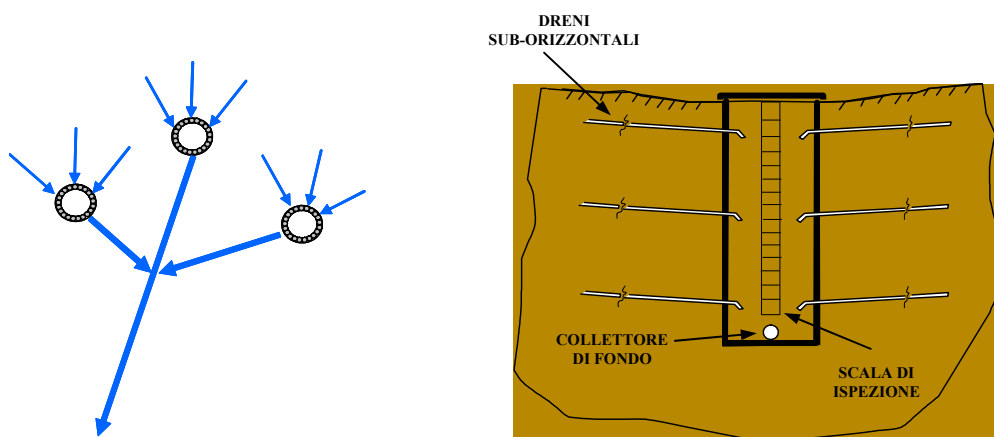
Rappresentazione schematica di un sistema di drenaggio profondo attraverso pozzi drenanti e dreni sub-orizzontali. A sinistra vista dall'alto del sistema di drenaggio: le frecce sottili in blu schematizzano dei dreni sub-orizzontali che si dipartono a raggiera dai pozzi; le frecce marcate (sempre in blu) i collettori di fondo per lo scarico delle acque raccolte dai vari pozzi. A destra vista in sezione di un pozzo drenante; si notano i dreni sub-orizzontali che scaricano nel pozzo ed in basso il collettore di fondo per lo scarico. Come schematizzato in figura, i pozzi sono generalmente predisposti per l'ispezione periodica finalizzata al controllo dell'efficacia del sistema drenante -
